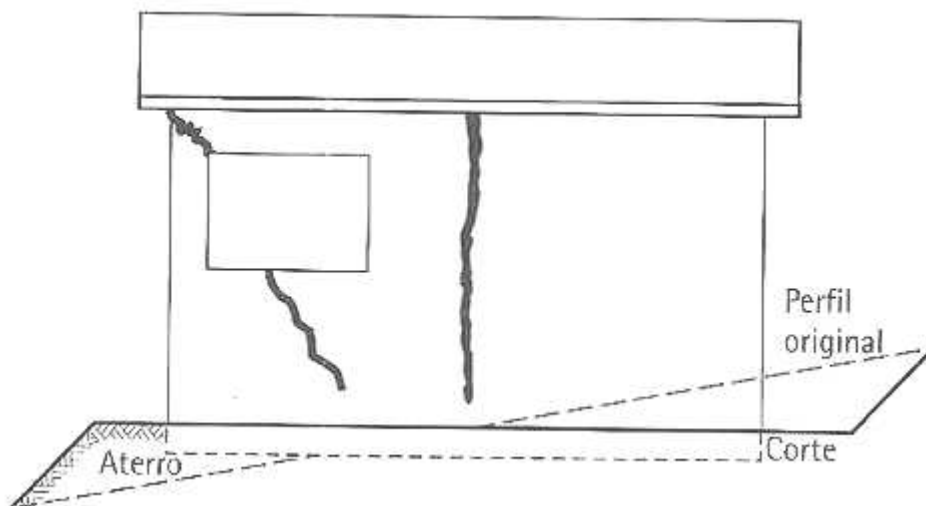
Provável fissuramento de edificação assente parte em corte e parte em aterro - CONSOLI; MILITITSKY; SCHINAID, 2008.
